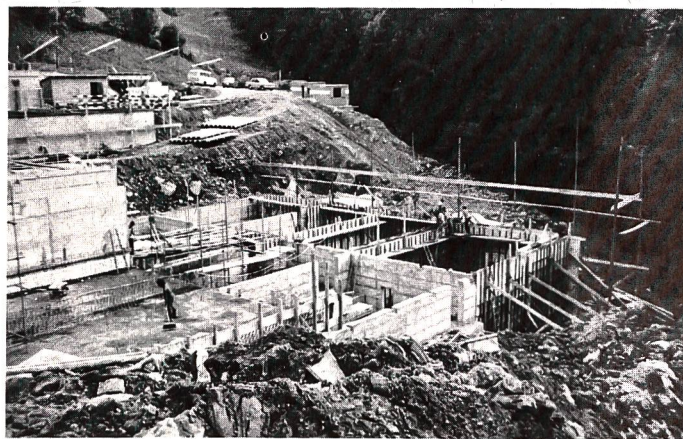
Blick auf die Belüftungs- und Nachklärbecken. Der Standort für den Faulraum mit Betriebsgebäude liegt rechts ausserhalb des Schnurgerüsts. Bauzustand August 1974
